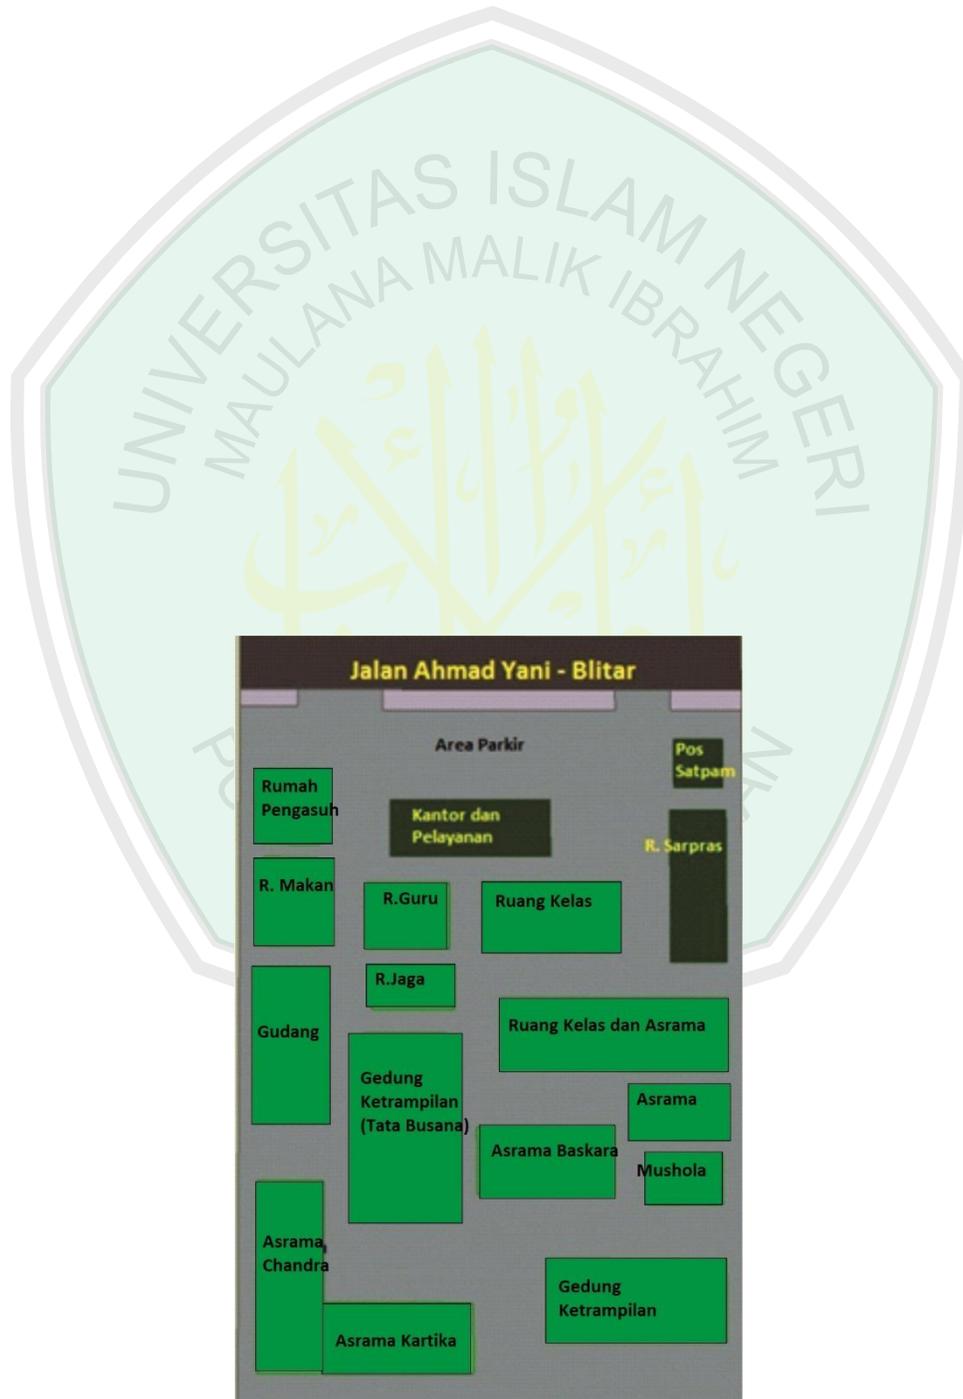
Site Plan Balai Ketrampilan Mardi Utama Blitar
